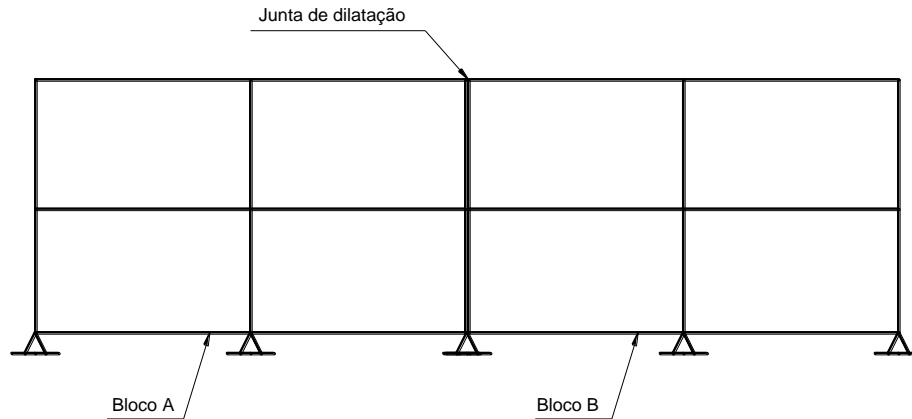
Separação da estrutura por juntas de dilatação.
